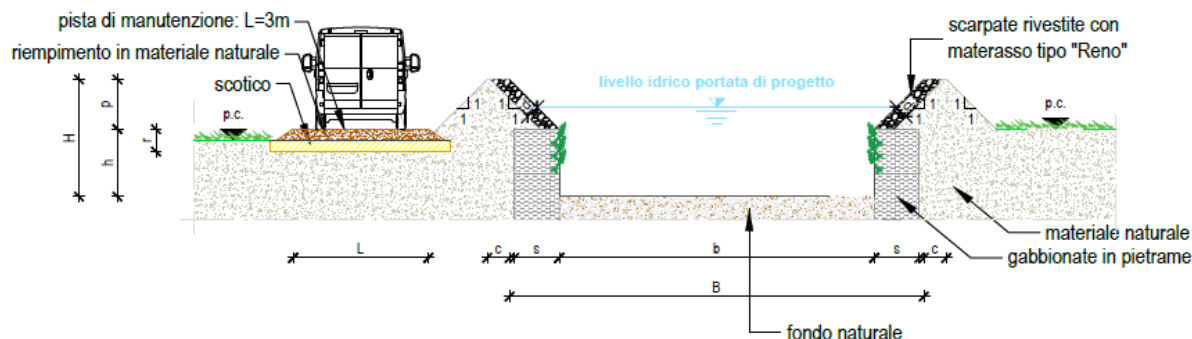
Sezione tipologica di progetto del tratto CIR-01-03 – completezza dell'intervento.
